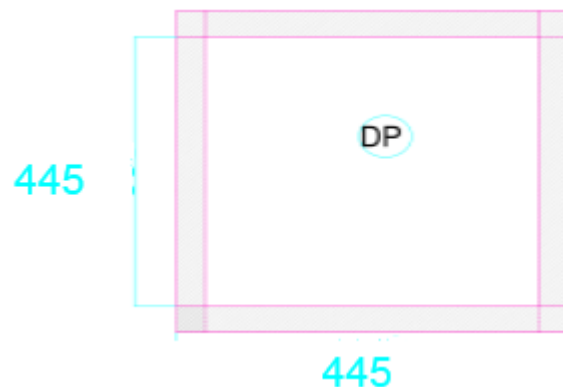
dalle pleine sur 4 appuis(RDC).
